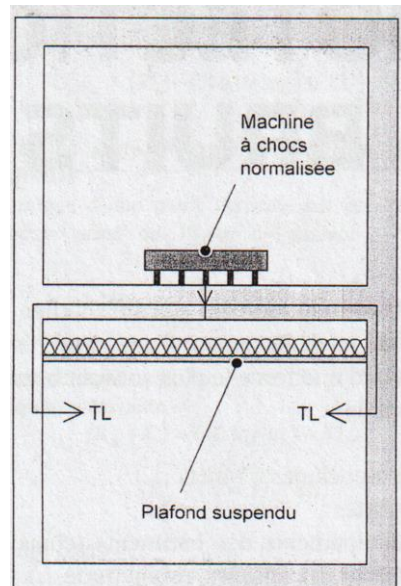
Le plafond suspendu comme dispositif d'isolation phonique (Hamayon, 2008)
